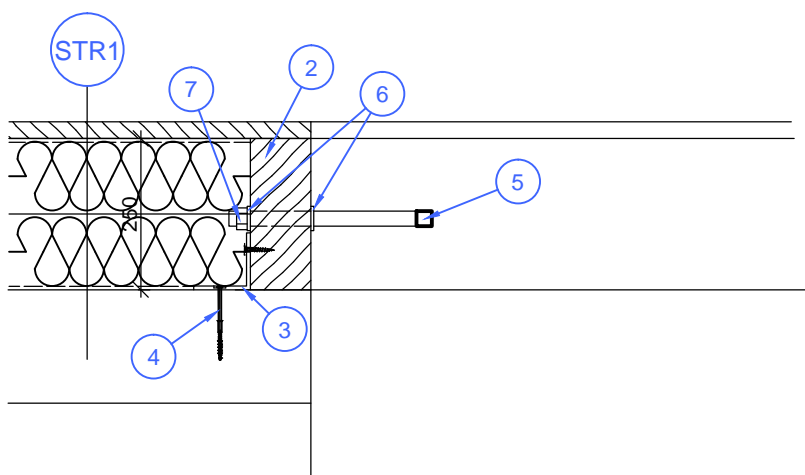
DETAIL POCHOZÍ LÁVKY
